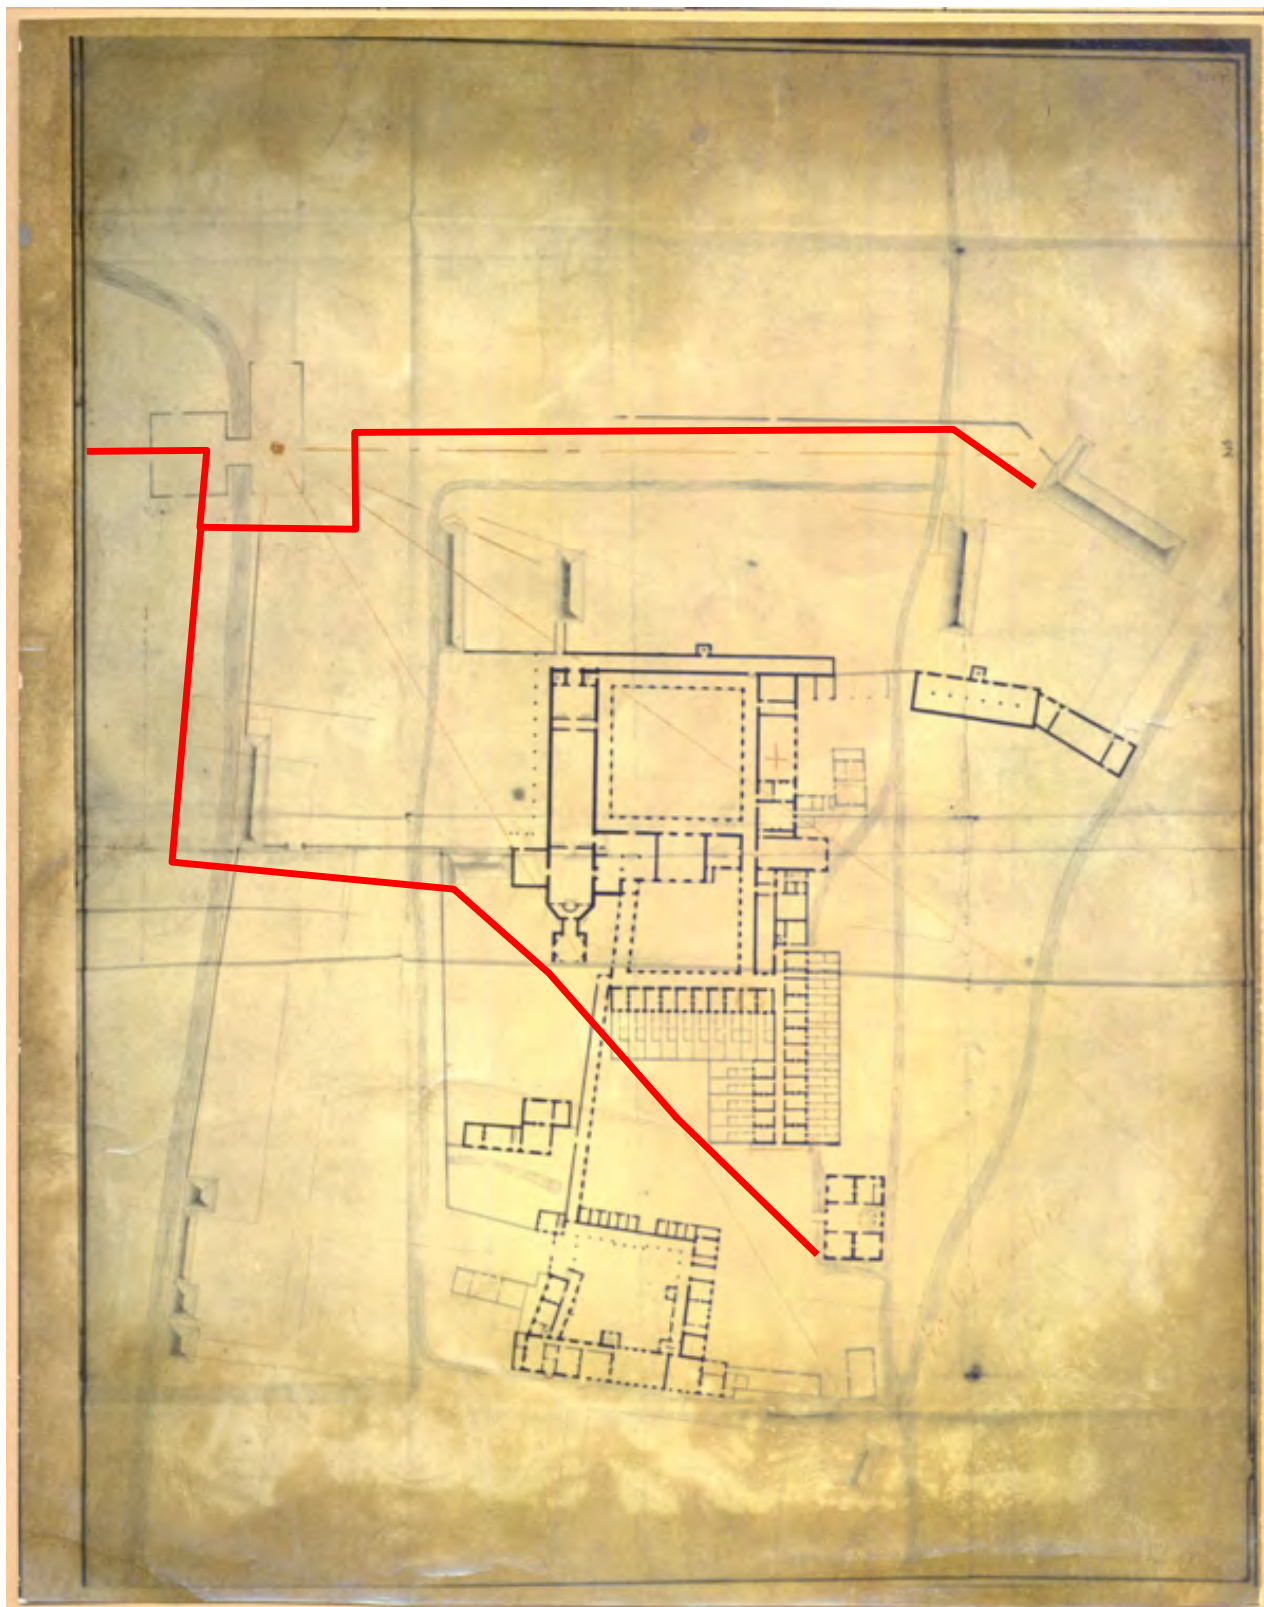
Opmetingsplan van architect Dewez met aanduiding van het projectgebied (Foto PCCE).
